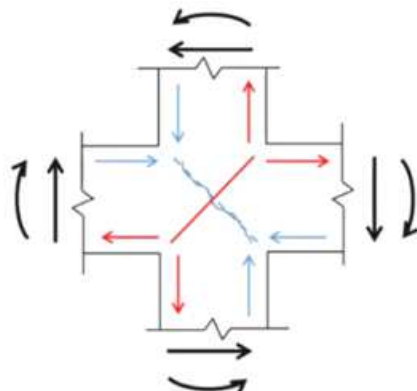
Cisaillement dans une jonction poutre-poteau [7].
